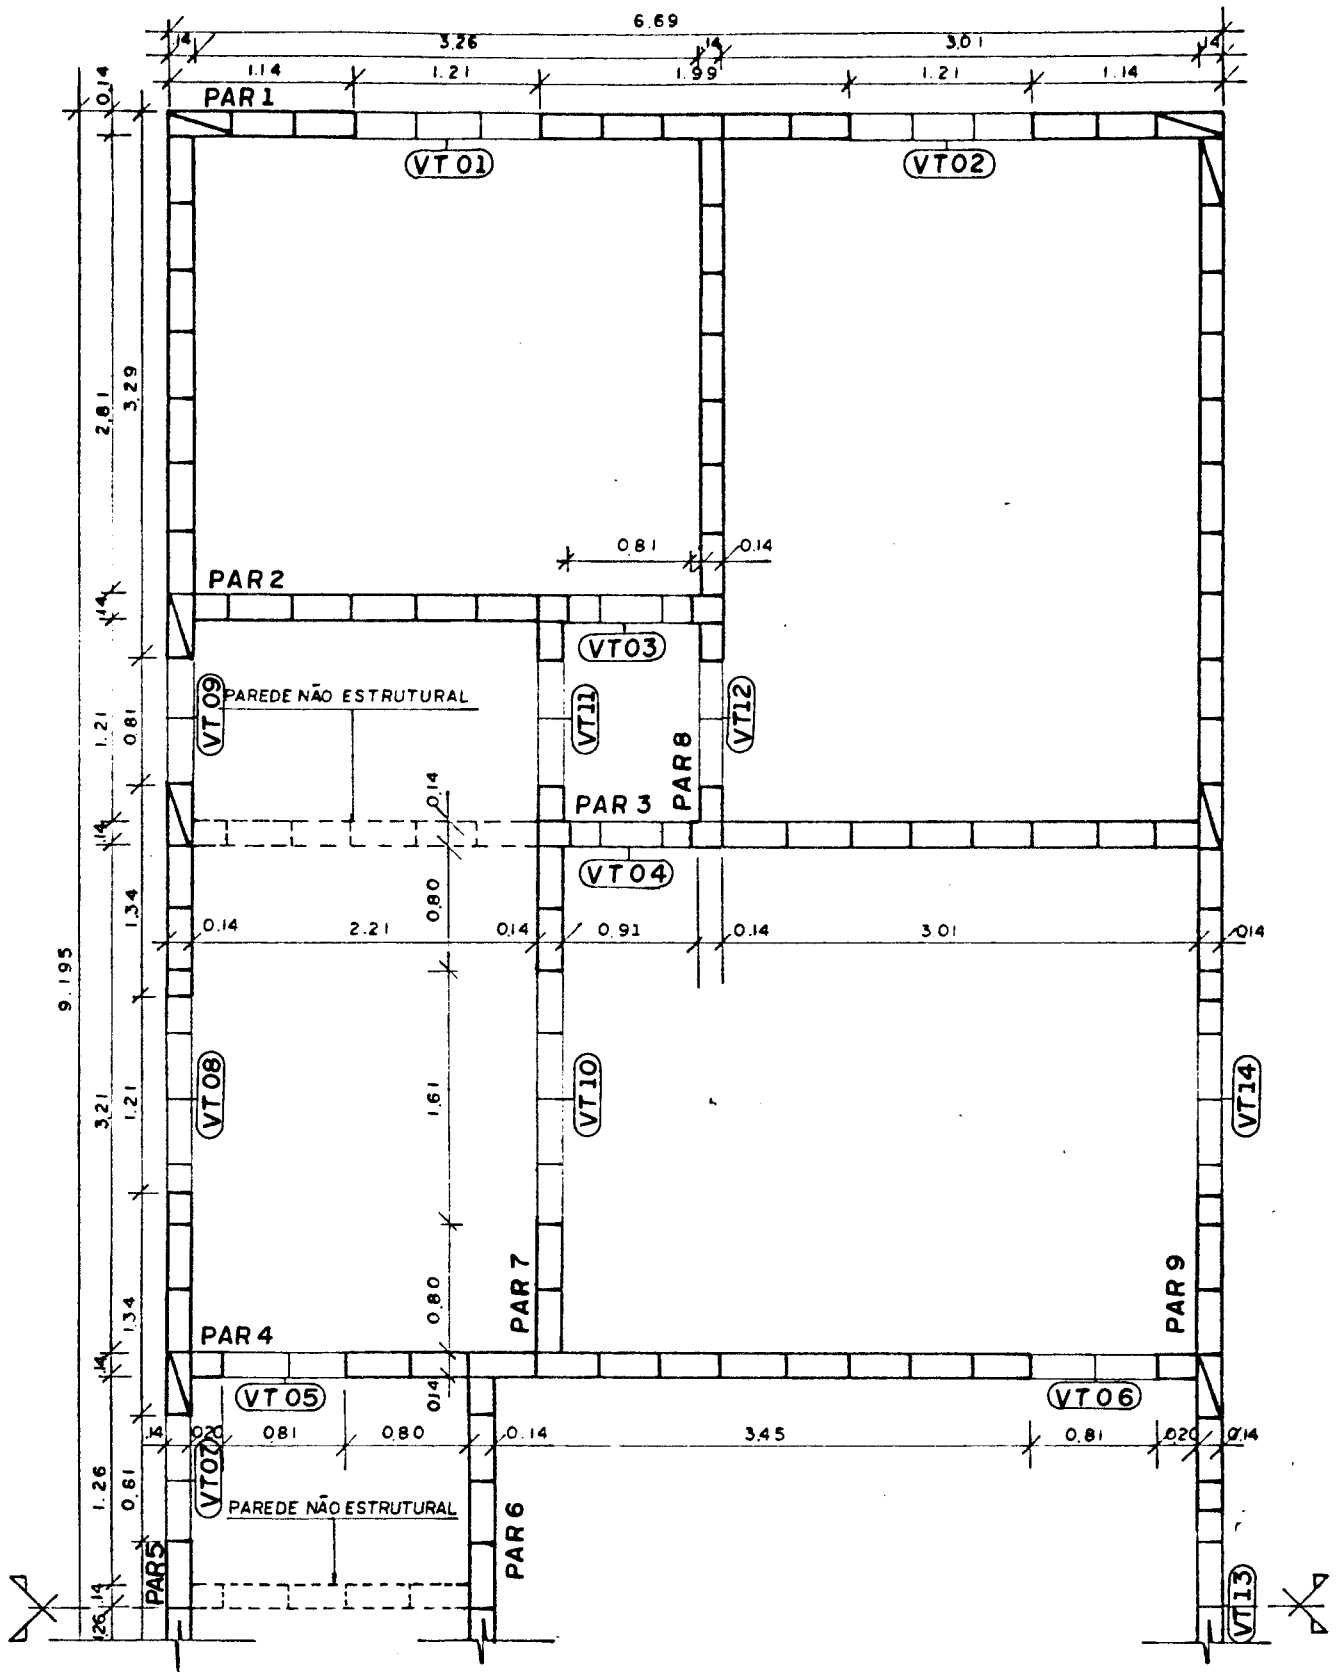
b. NOMENCLATURA DAS VERGAS E PAREDES DO TÉRREO, 1º e 2º PAVIMENTO.
